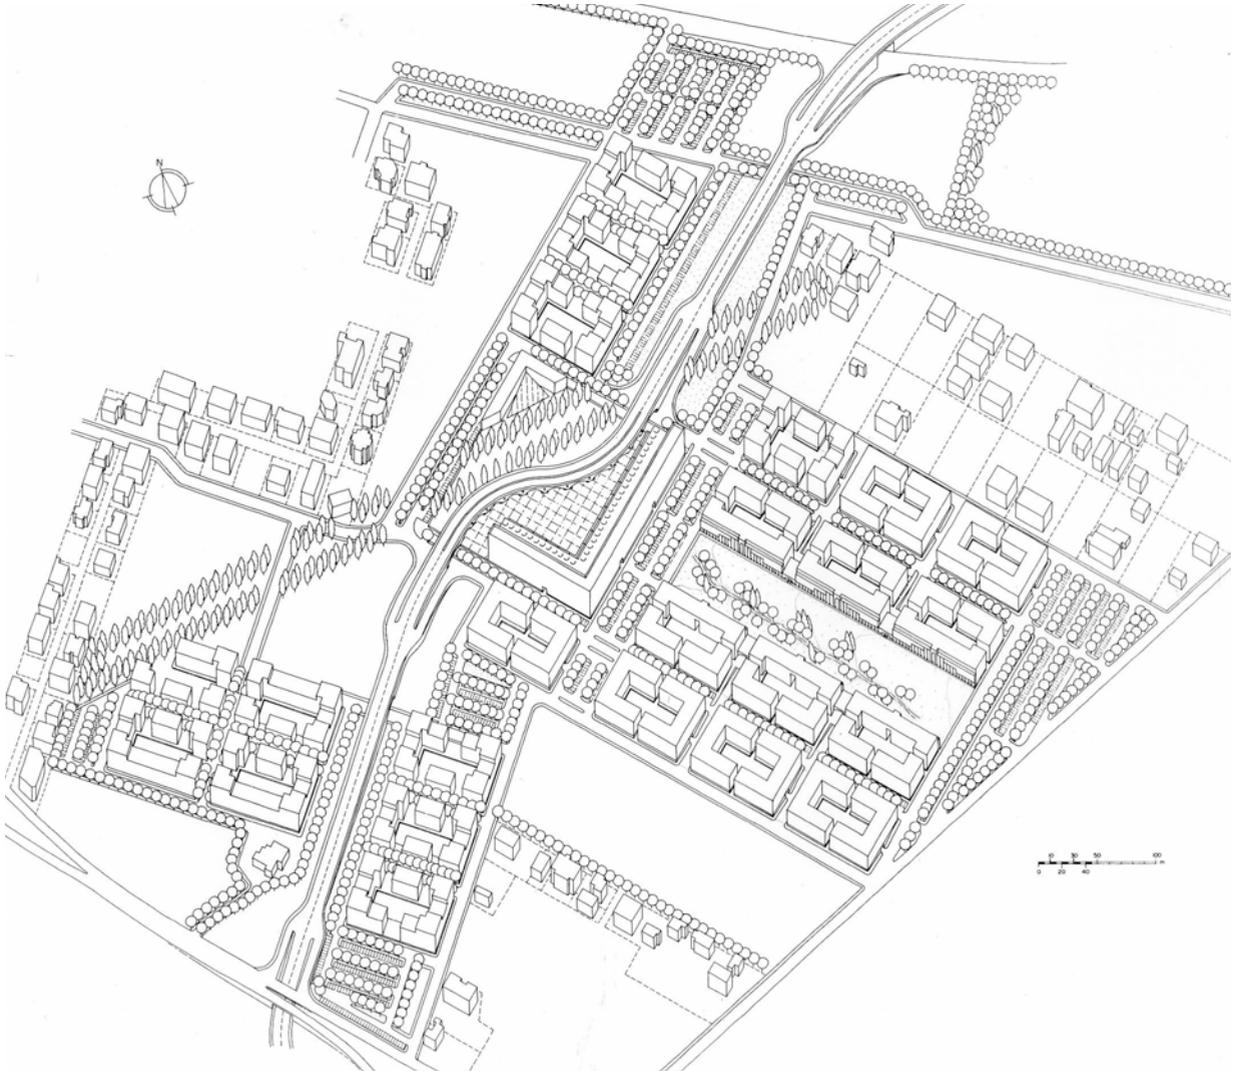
Planimetria con partizione e fili fissi degli isolati
